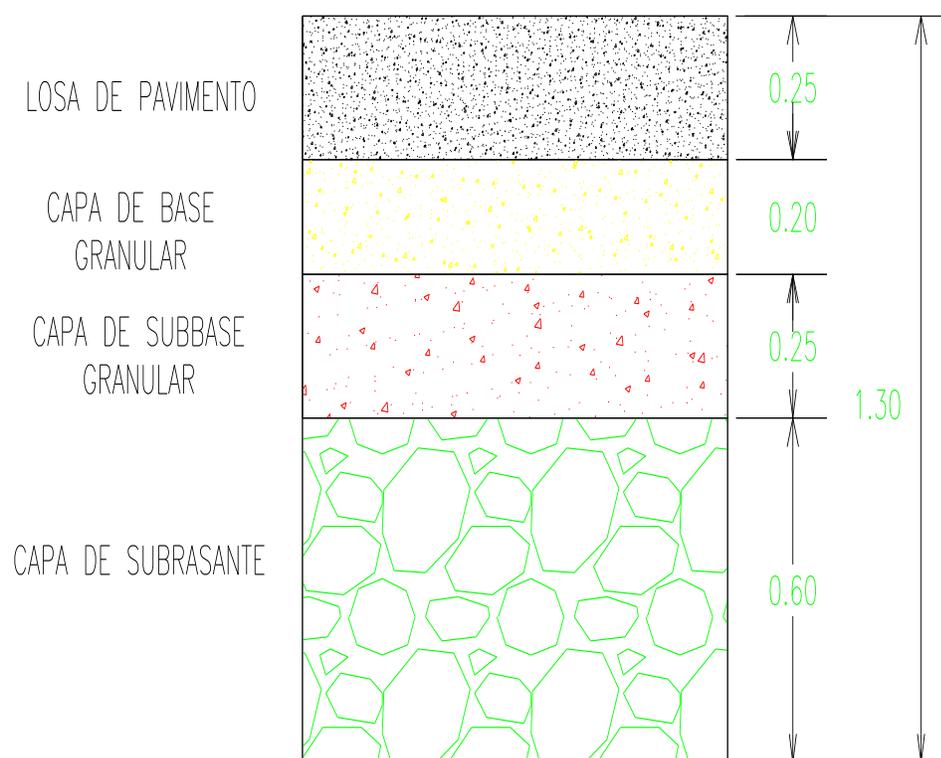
Detalle de estructura de Pavimento (Fuente: Pasante)
